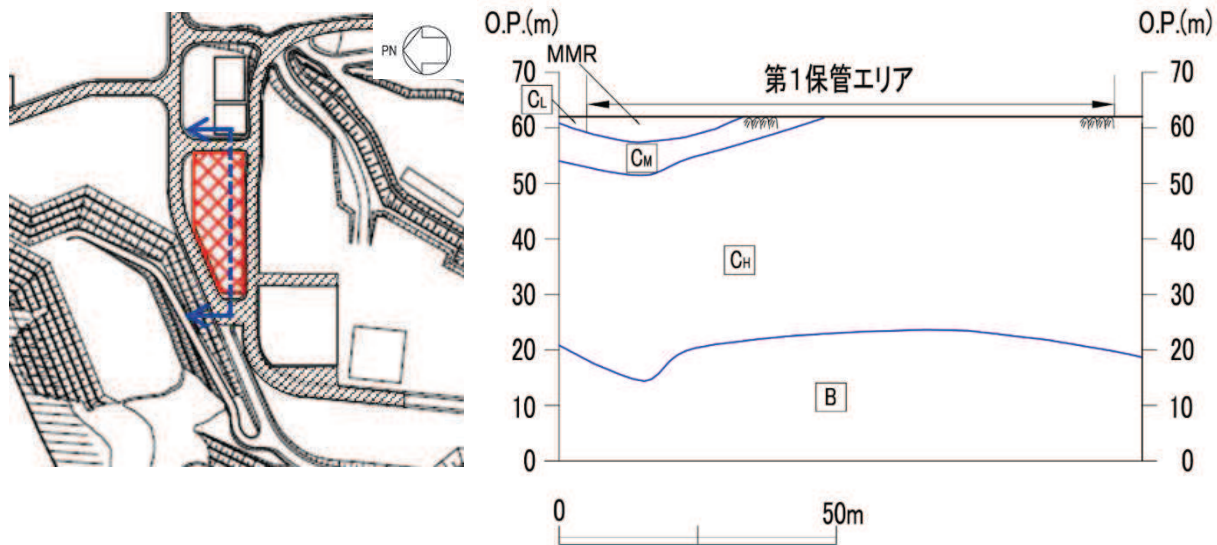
第1保管エリアの平面図及び地質断面図
